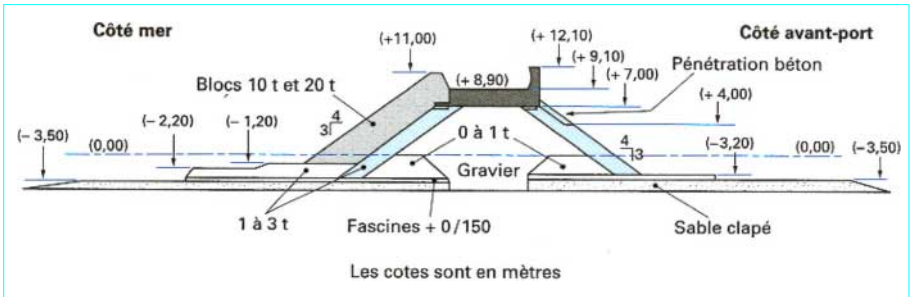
Port de Dunkerque : coupe type des digues Nord et Est
